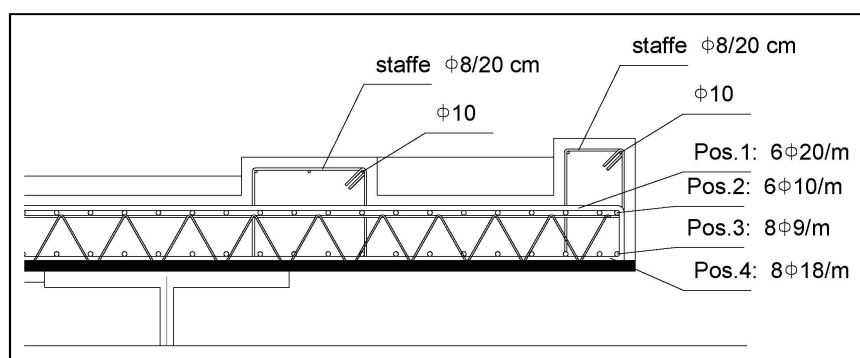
Armatura in zona 2, lontano dalle estremità
